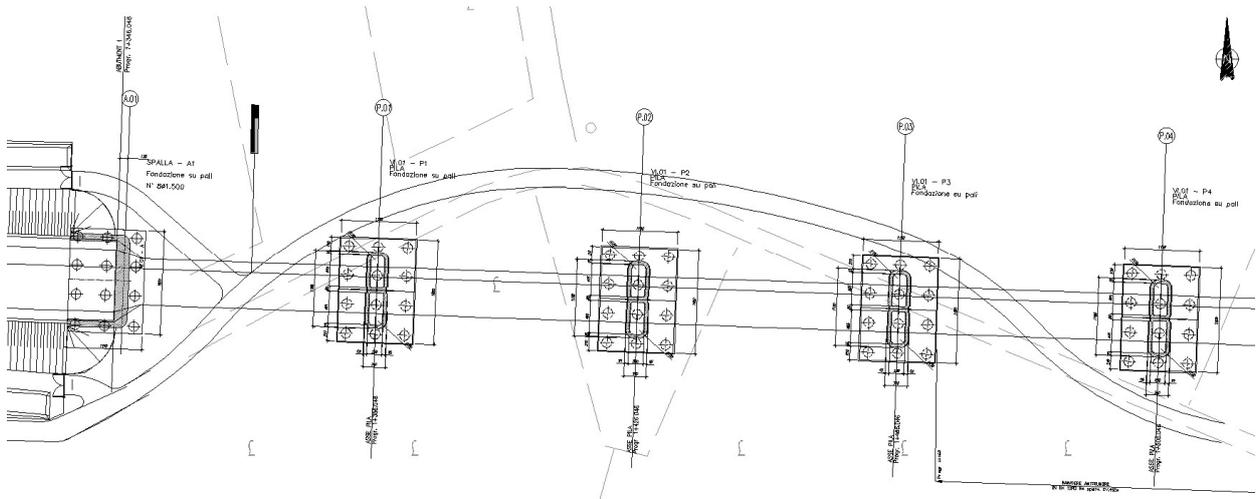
Pianta fondazioni - Ponte a struttura mista acciaio calcestruzzo a doppio binario
